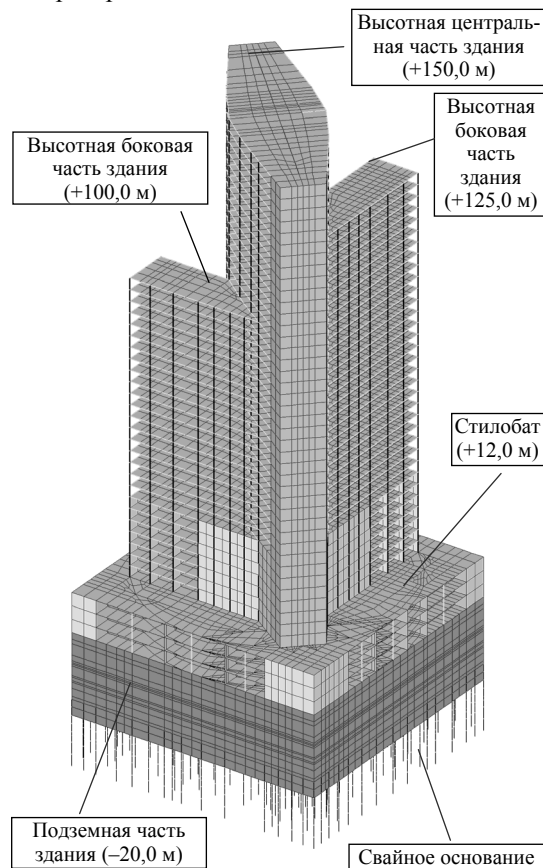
Фрагмент расчетной схемы конструкции высотного здания с подземной частью
